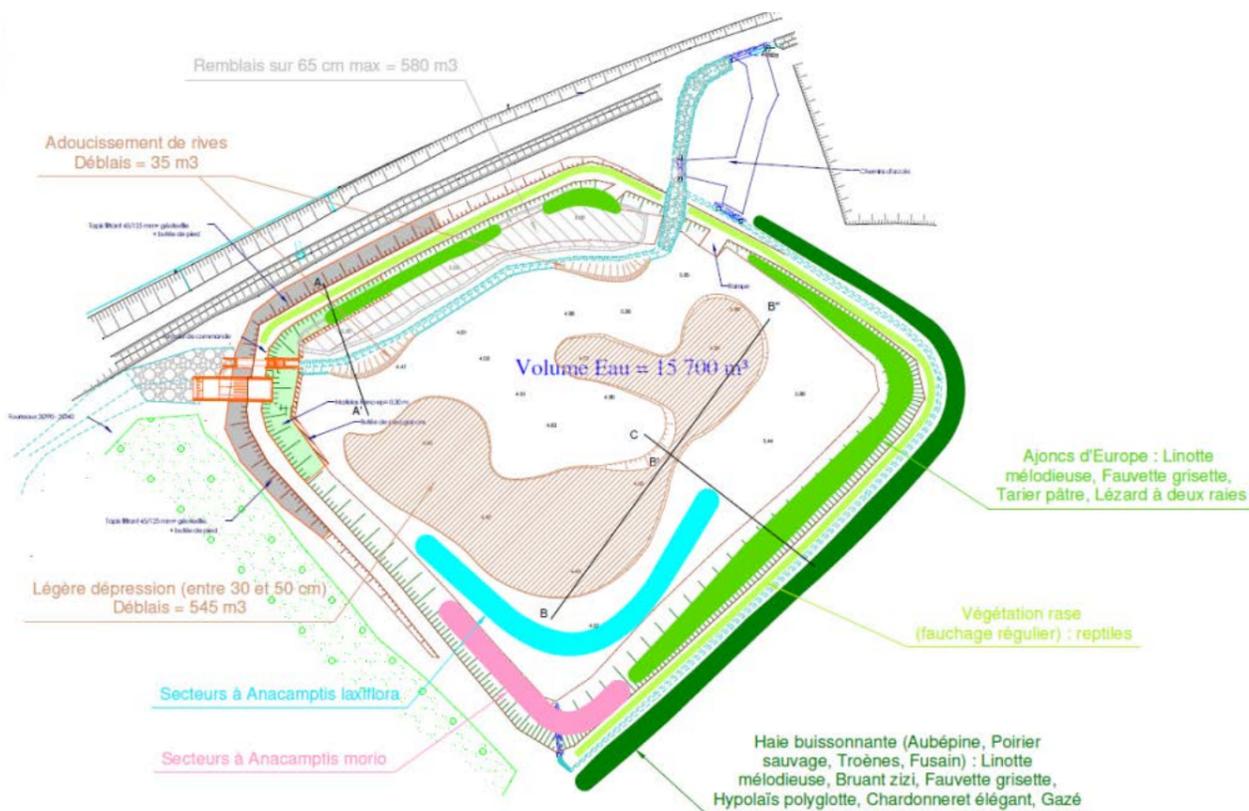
Mesures compensatoires proposées sur le site de Pont Saillant en 2020
